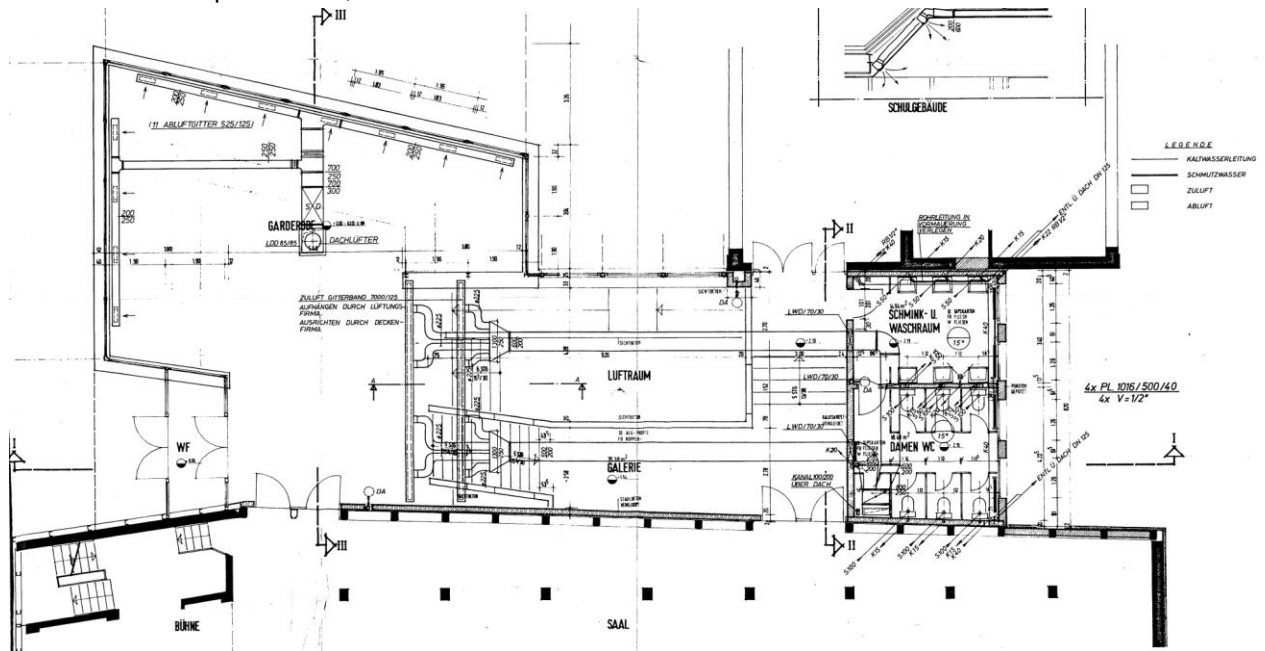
Grundriss des Aulafoyers EG-OG Bestandsplan
